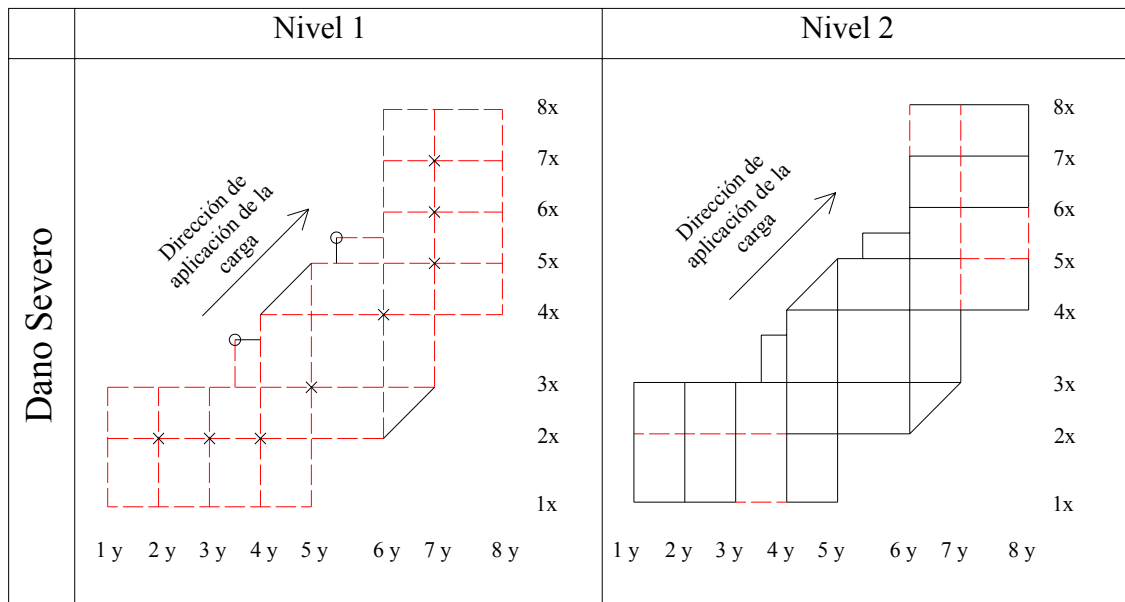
21 Vista en planta Niveles 1 y 2, para E.L. de D.S.
